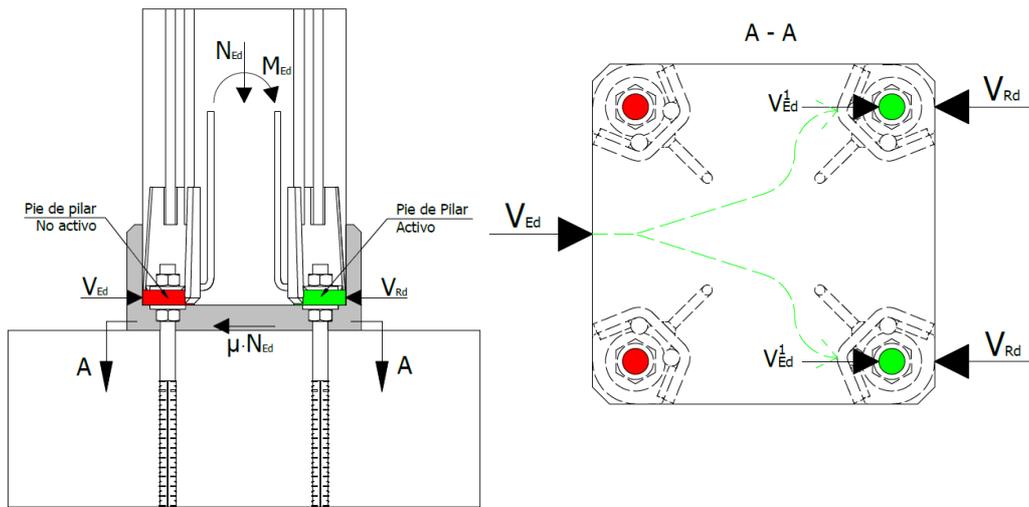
Distribución del esfuerzo cortante en los pies de pilar según TR068
